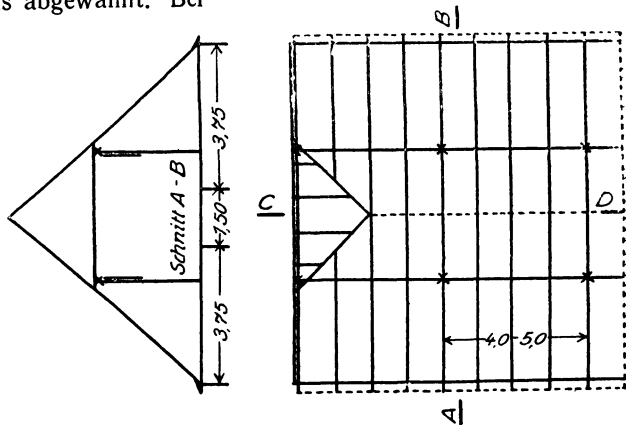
Kehlbalkendach mit Krüppelwalm.
